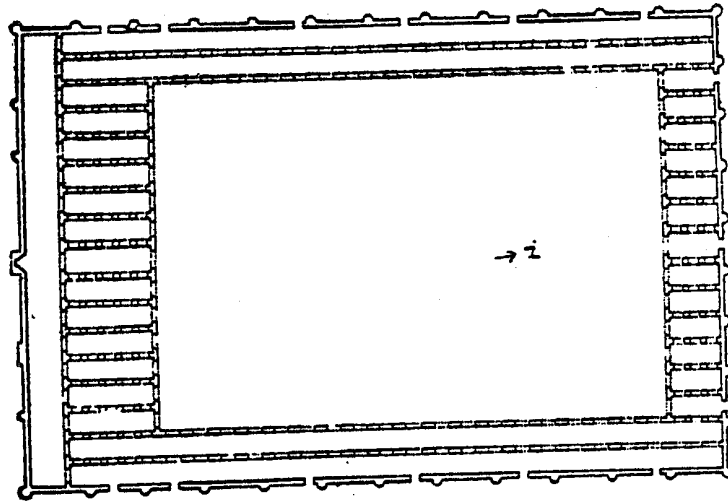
مسقط أفقي لجامع طارق خانه بدمغان (عن : Creswell)
